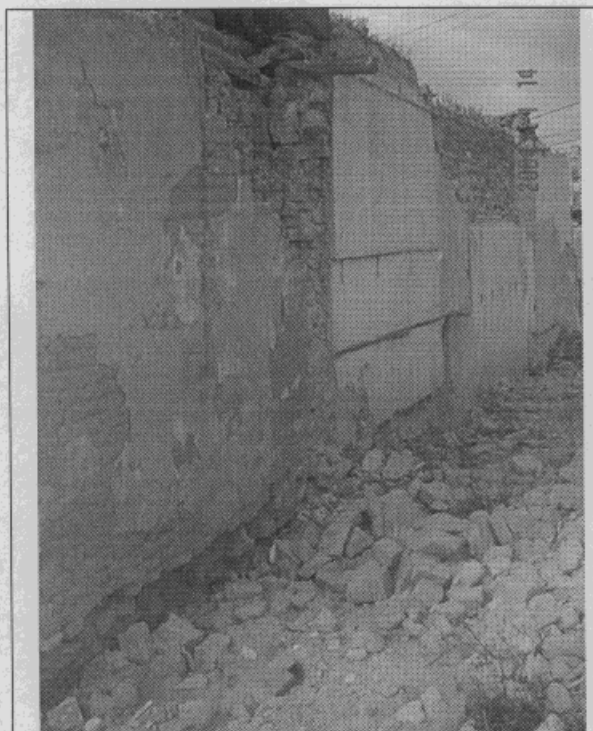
Deterioro en la base del muro del costado oriental. El material de demolición depositado en el predio vecino genera empujes al muro del sótano (ver foto 6).
